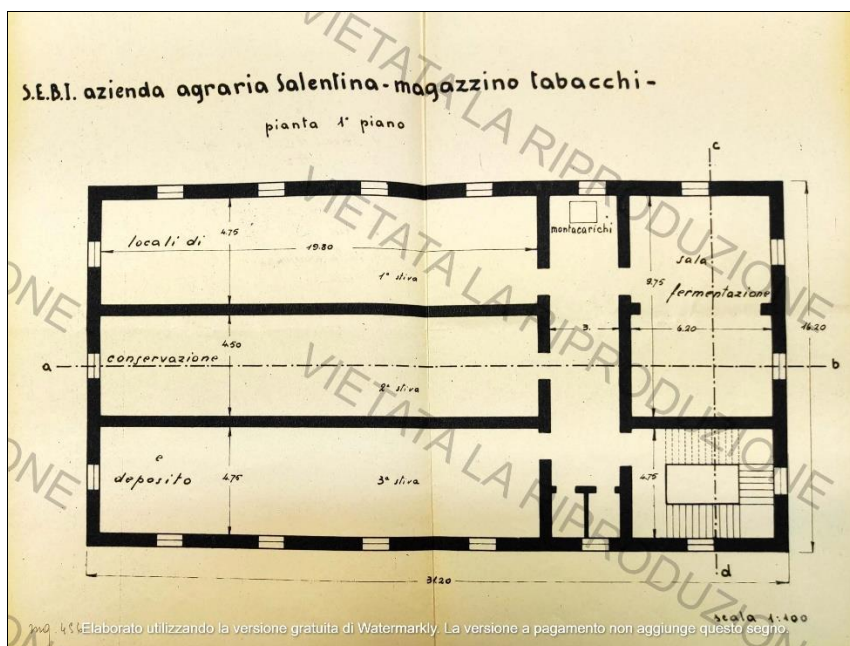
Magazzino Tabacchi. Planimetria 1° piano (Archivio di Stato di Lecce, Direzione Compartmentale Tabacchi, Fascicolo 567, busta 152, a.1968)
